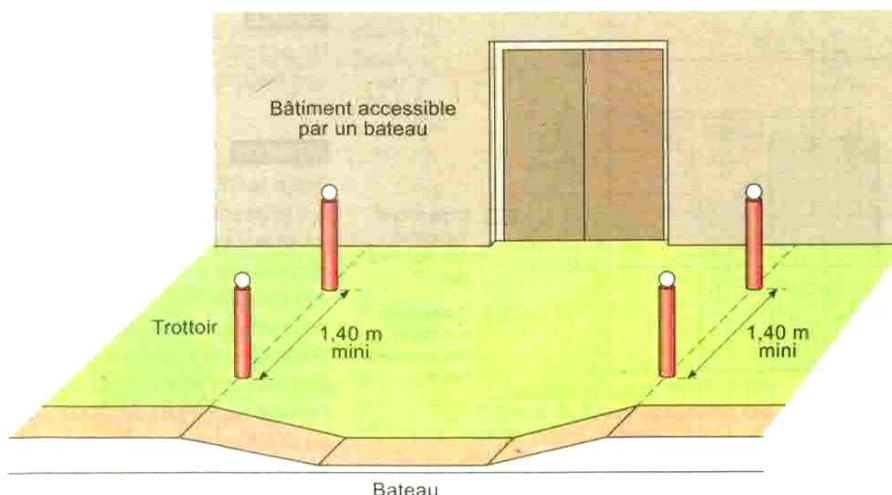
Exemple d'implantation de poteaux pour la protection contre le stationnement.
